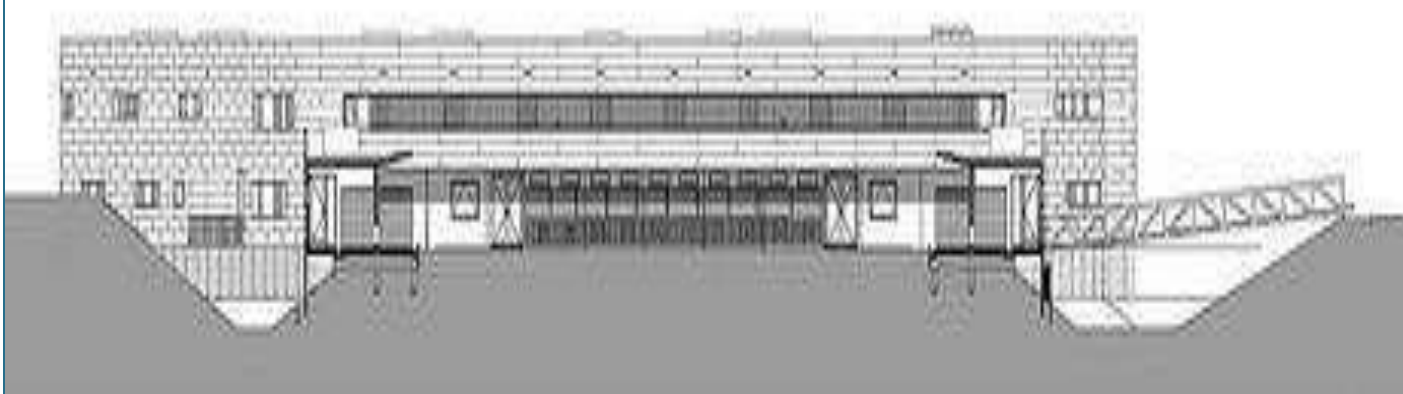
Sección B, al Sureste del Centro. Donde se aprecian los boxes para los canes al centro y a cada extremo, y el puente del acceso secundario. Fuente: <https://www.flickr.com/photos/>
